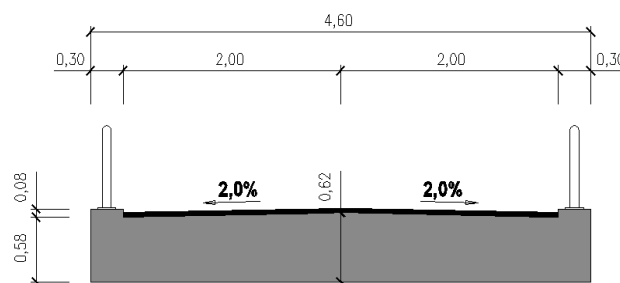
Secção transversal do tabuleiro existente, Estudo de Caso II.
